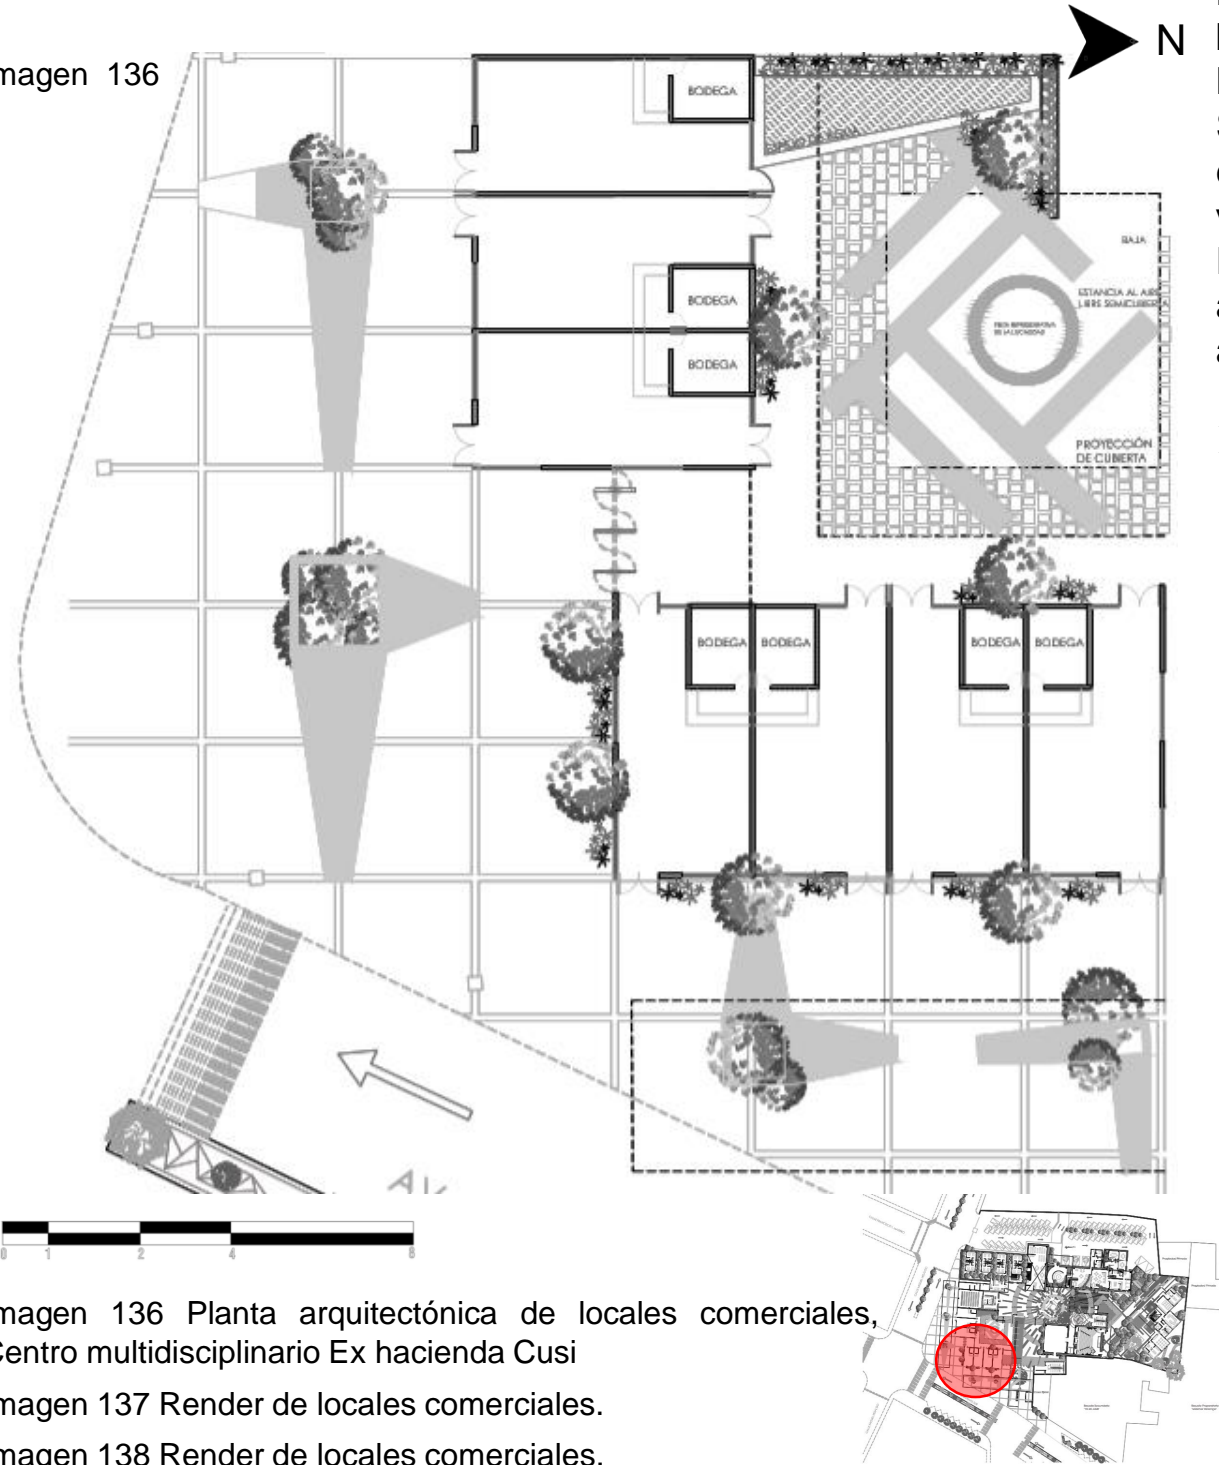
Planta arquitectónica de locales comerciales, Centro multidisciplinario Ex hacienda Cusi
